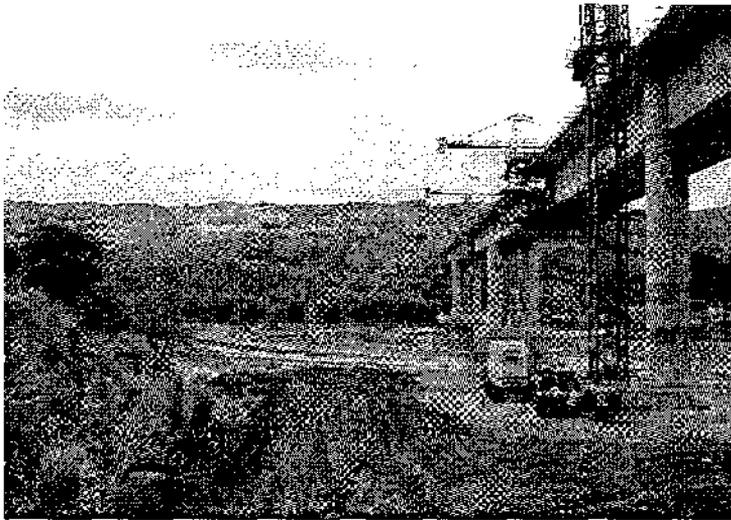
Aquí pueden apreciarse las zapatas y las columnas
